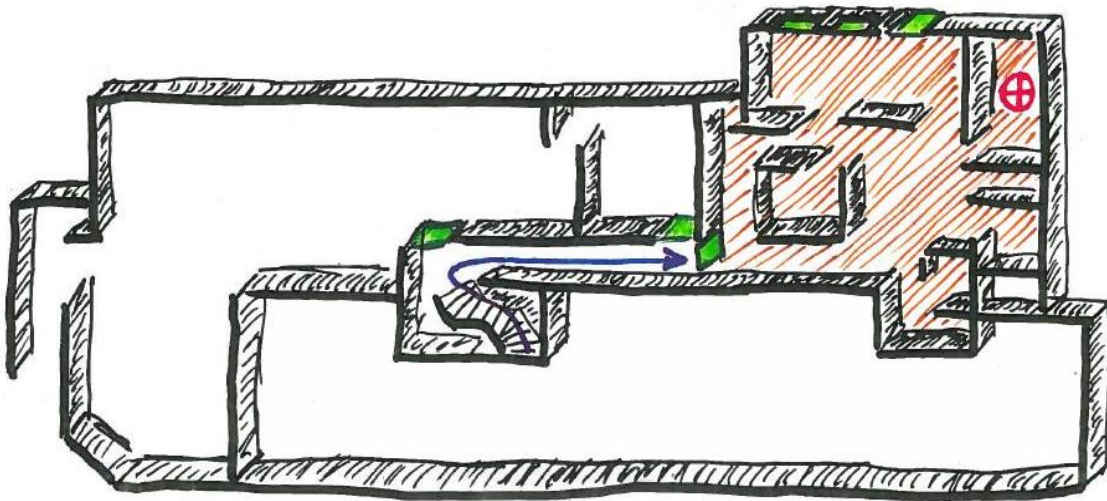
Grundriss Untergeschoss und Angriffsweg Atemschutztrupp
